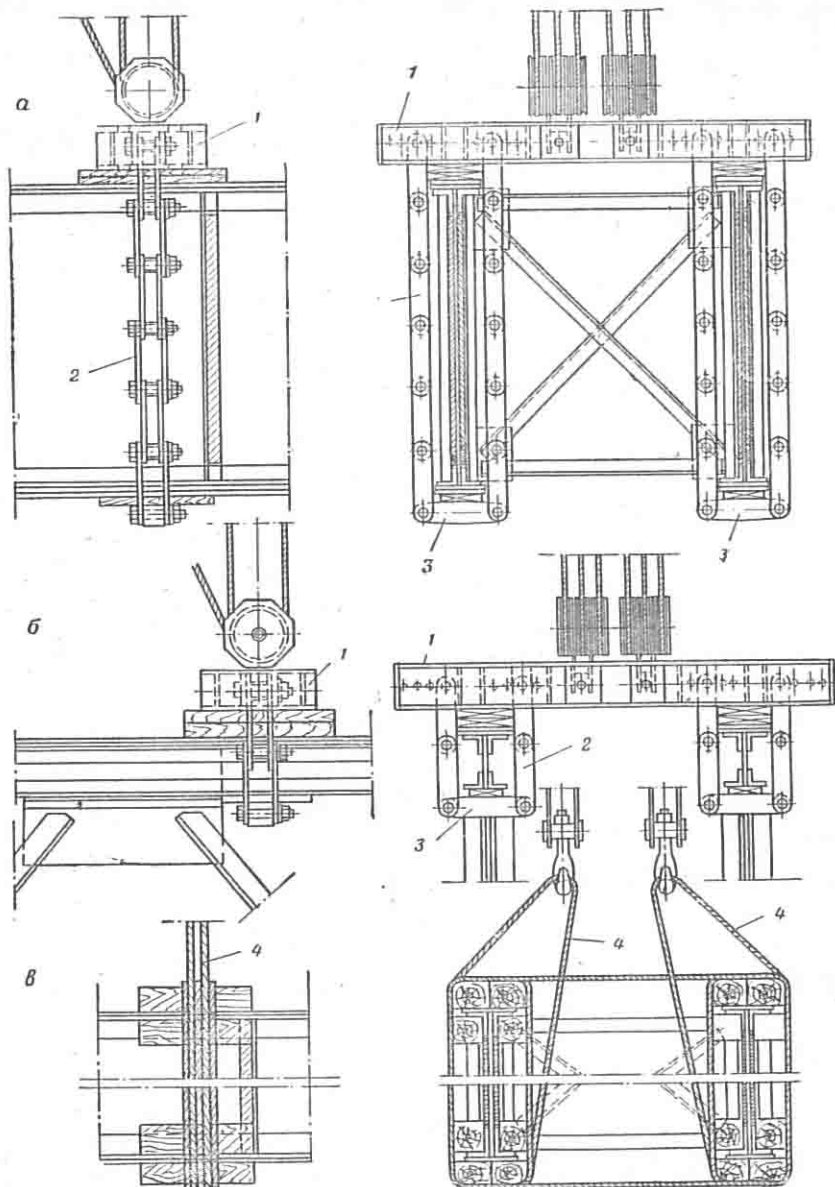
Строповка металлических пролетных строений к консольным кранам: а — строповка под нижние пояса пролетного строения со сплошной стенкой при помощи шарнирных цепей; б — то же, за верхние пояса пролетного строения с треугольной решеткой; в — строповка пролетного строения со сплошной стенкой под нижние пояса при помощи тросовых стропов; 1 — строповочная балка; 2 — шарнирные цепи; 3 — грузовые балочки; 4 — тросовый строп
